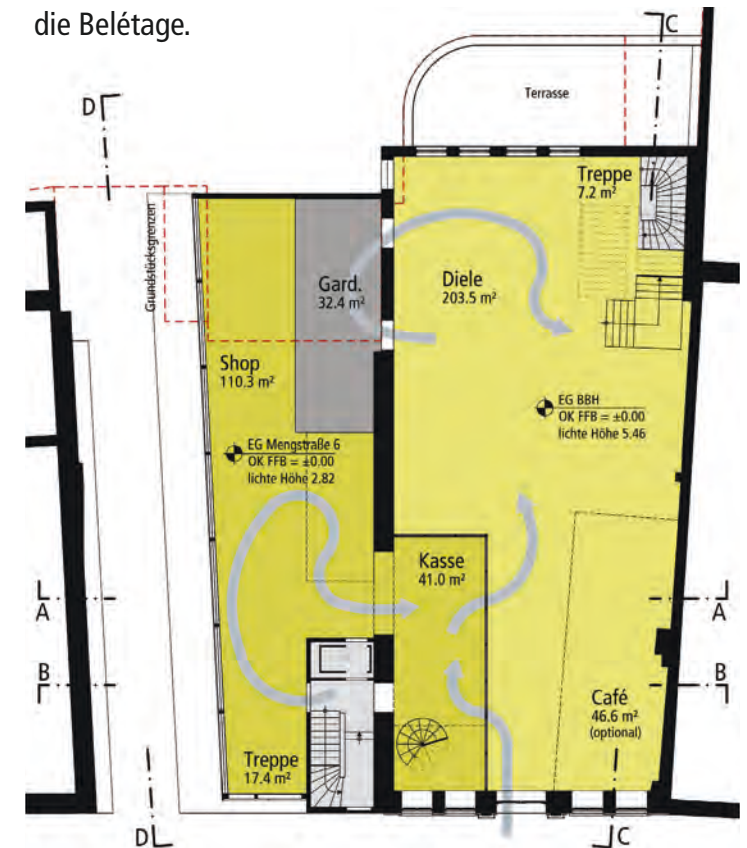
Variante 3, Grundriss Erdgeschoss
